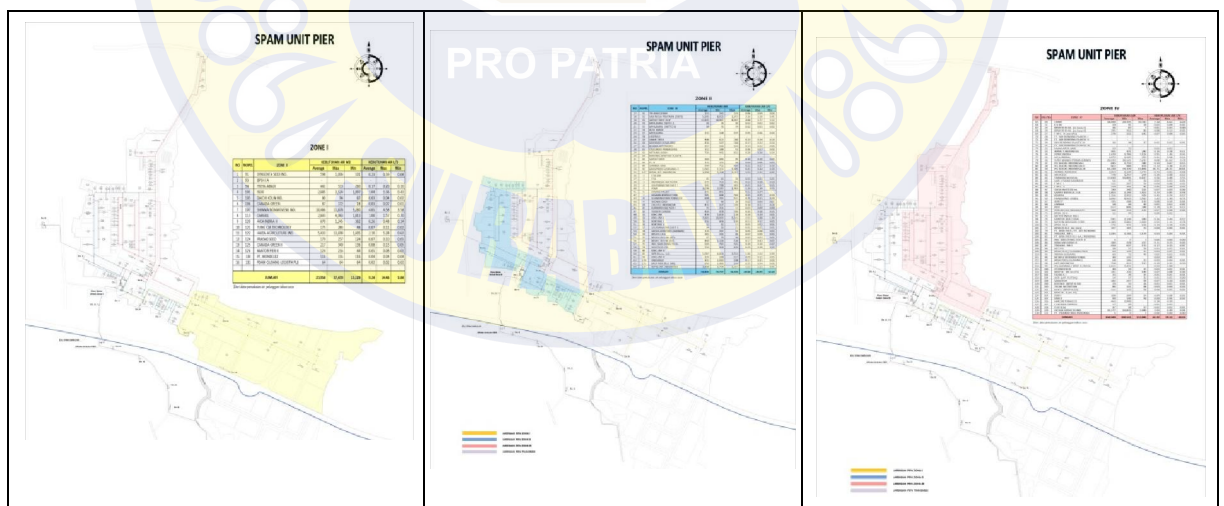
Layout Kawasan Industri Pier – Pasuruan
